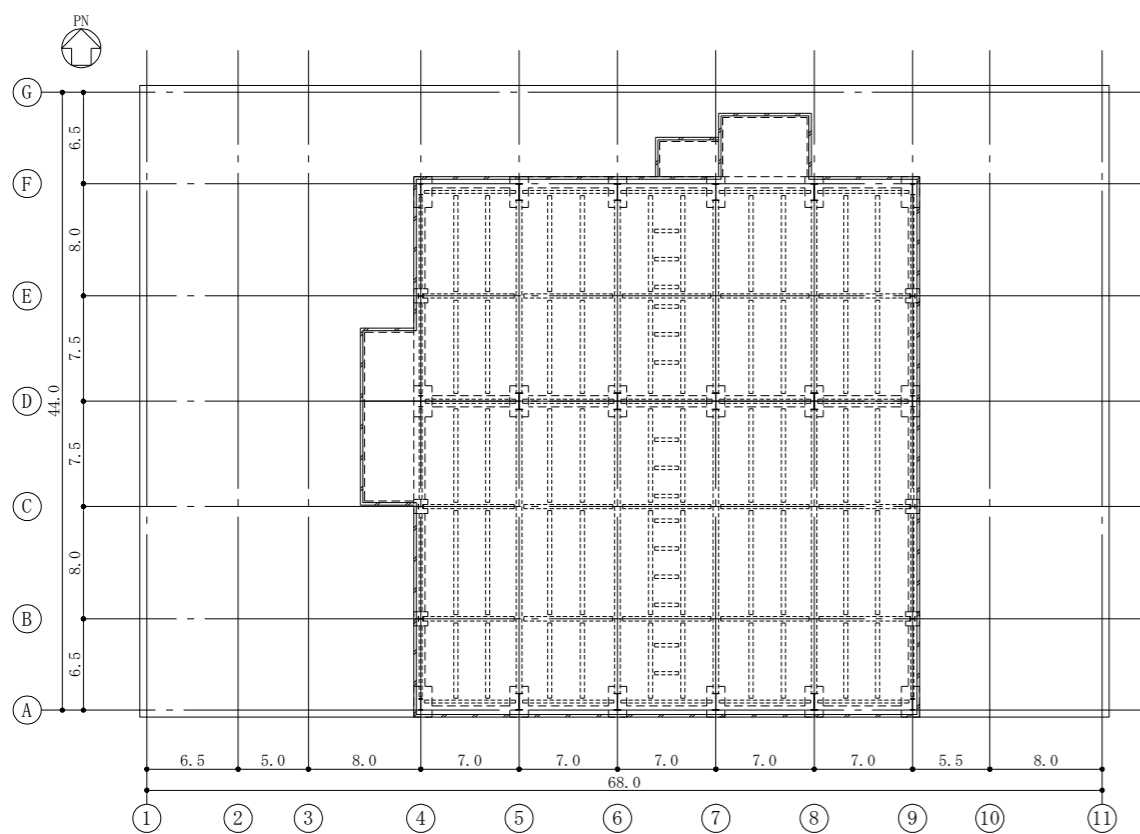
屋根平面図 (その2) (O.P. 48.8) (単位:m)
